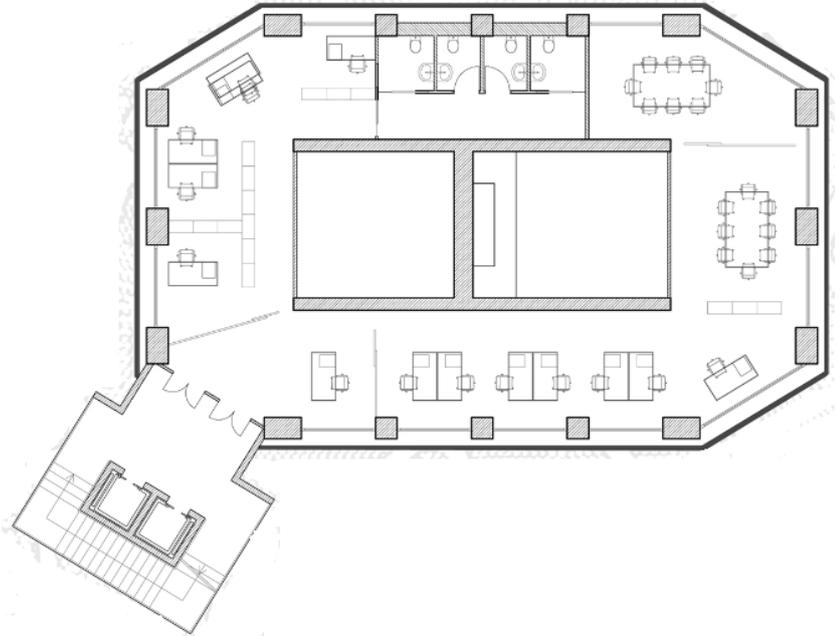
Planimetria della torre serbatoio secondo la soluzione progettuale individuata
